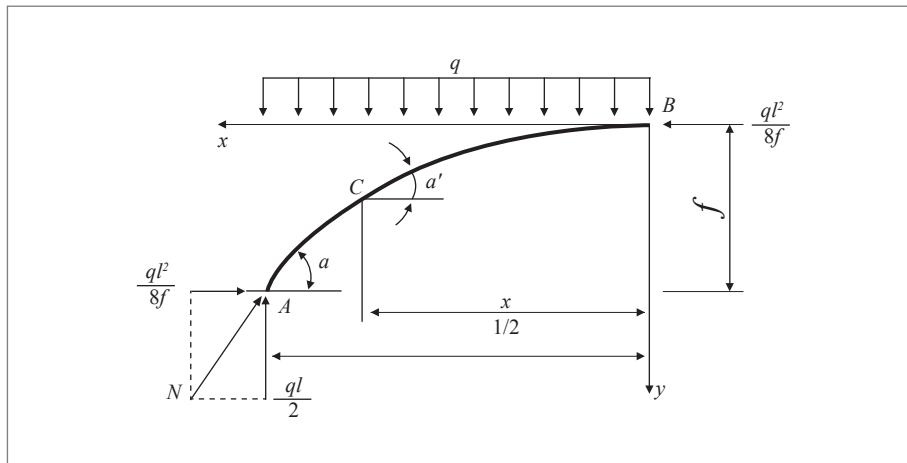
Incremento de carga en apoyos por estructuras arqueadas. [FUENTE: Liang-Wei Jiang, 2004]
